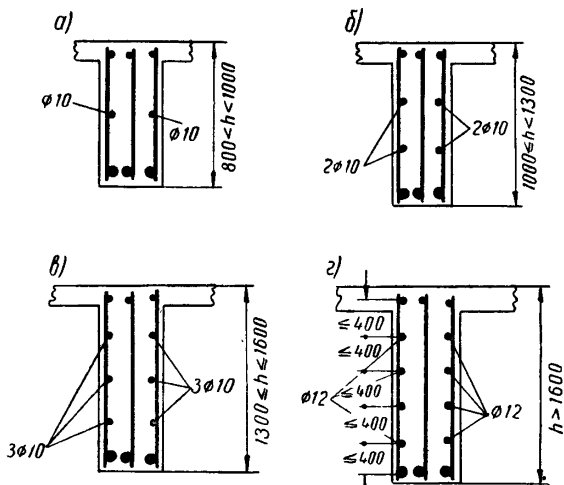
Армирование боковых граней балок высотой  $h > 800$  мм конструктивной продольной арматурой
